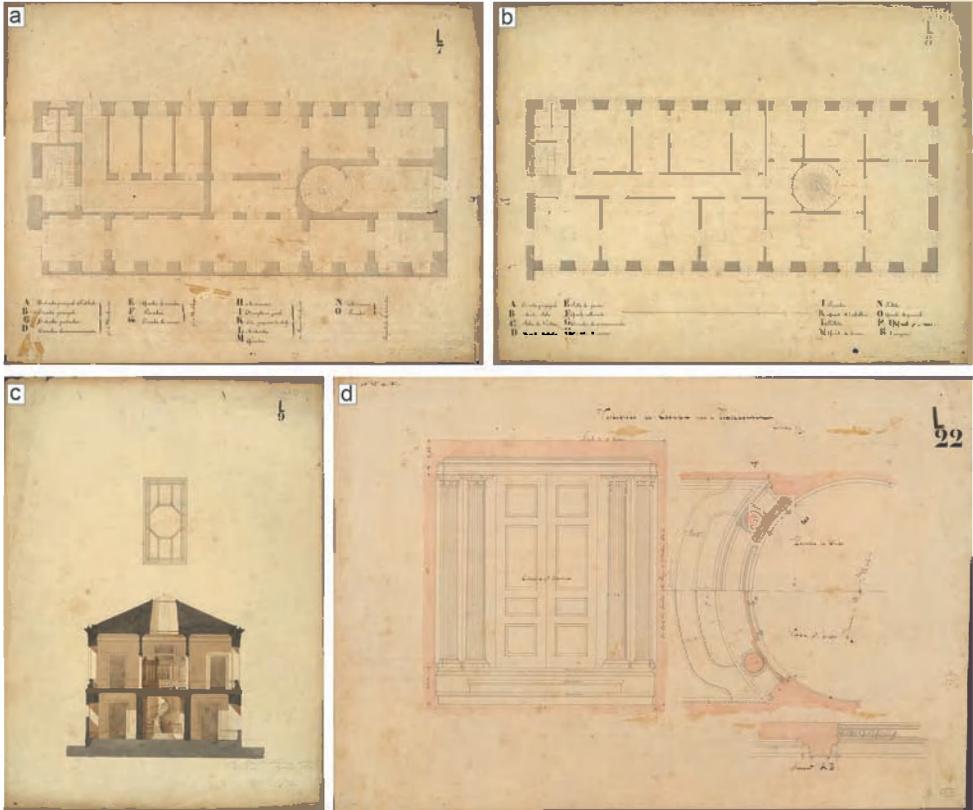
Pranchas do projeto da Casa dos Semanários, de autoria de Th. Marx: a. Planta baixa do pavimento térreo, 1859; b. Planta baixa do primeiro pavimento, 1859; c. Corte transversal, 1859; d. Detalhes do vestíbulo da escada, s/data. Fonte: Fundação Biblioteca Nacional.
